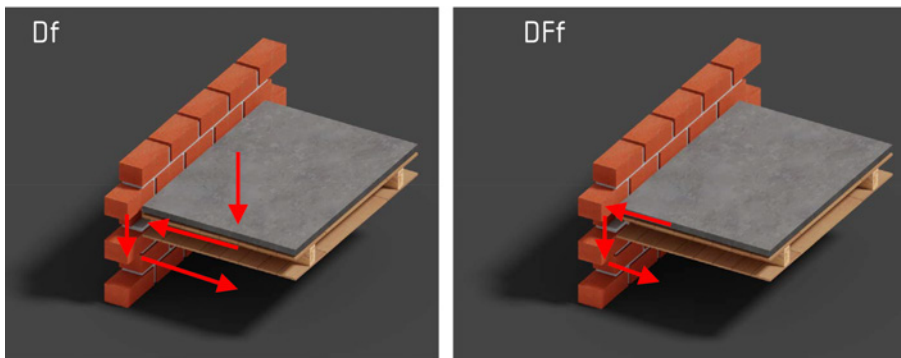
Flankierende Schallübertragung bei Holzbalkendecken mit schwimmendem Estrich nach DIN 4109-2:2018; links: Flankenweg Df über die Träger der Holzbalkendecke, rechts: Flankenweg DfF über den Randanschluss des schwimmenden Estrichs
